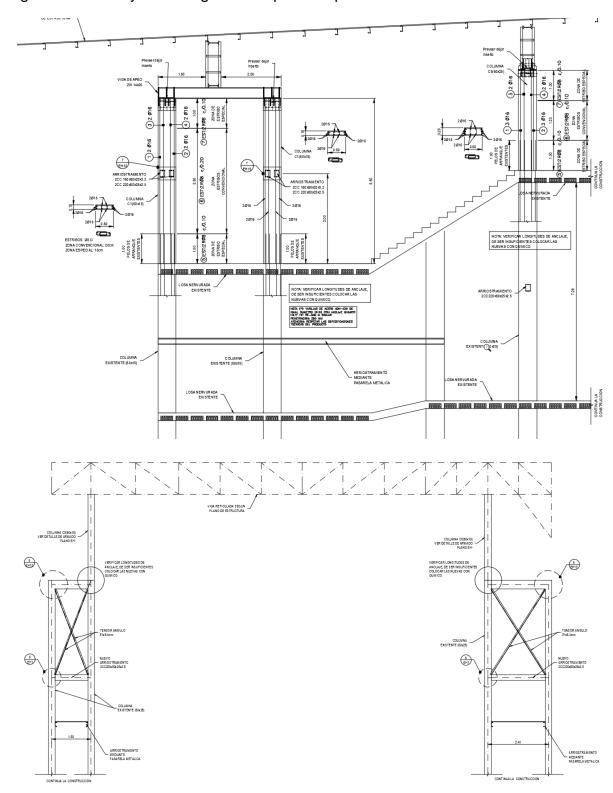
Vistas de Armadura de Columnas Nuevas y Refuerzos de Arriostramientos de Columnas de apoyo de cubierta.
